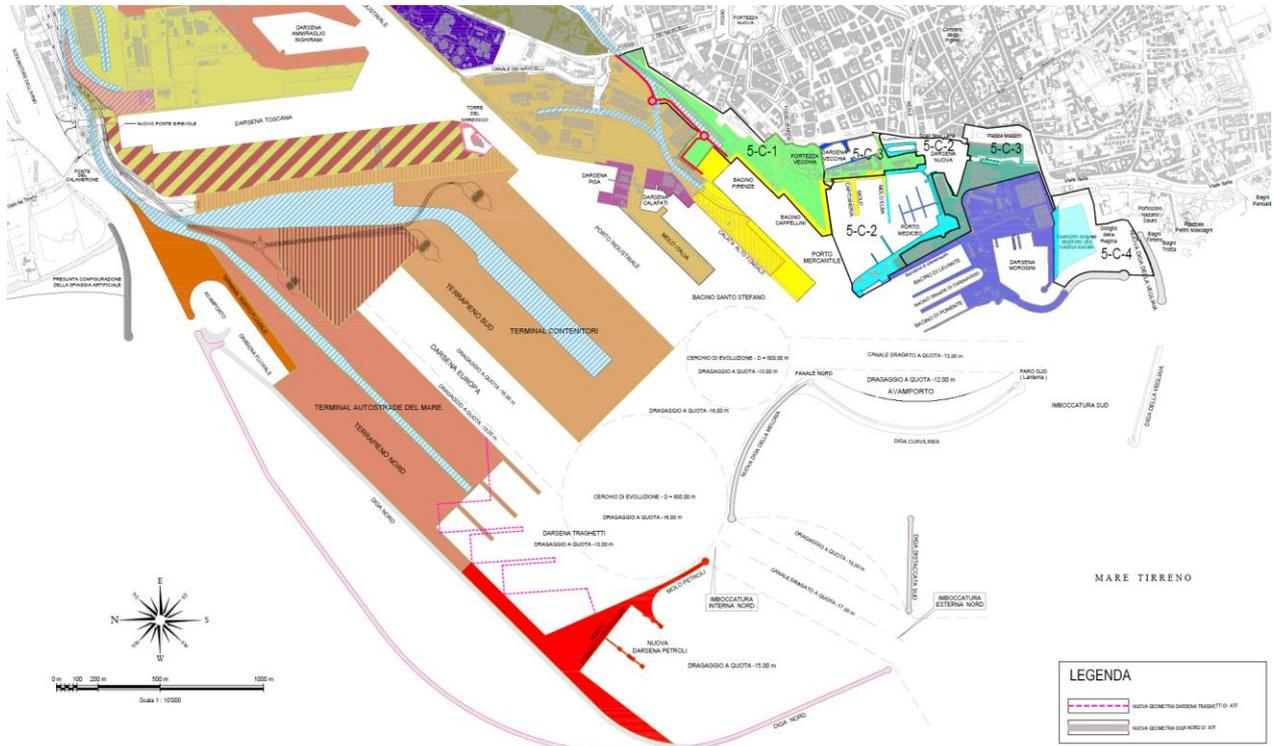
planimetria generale. Sovrapposizione PRP vigente con ATF
